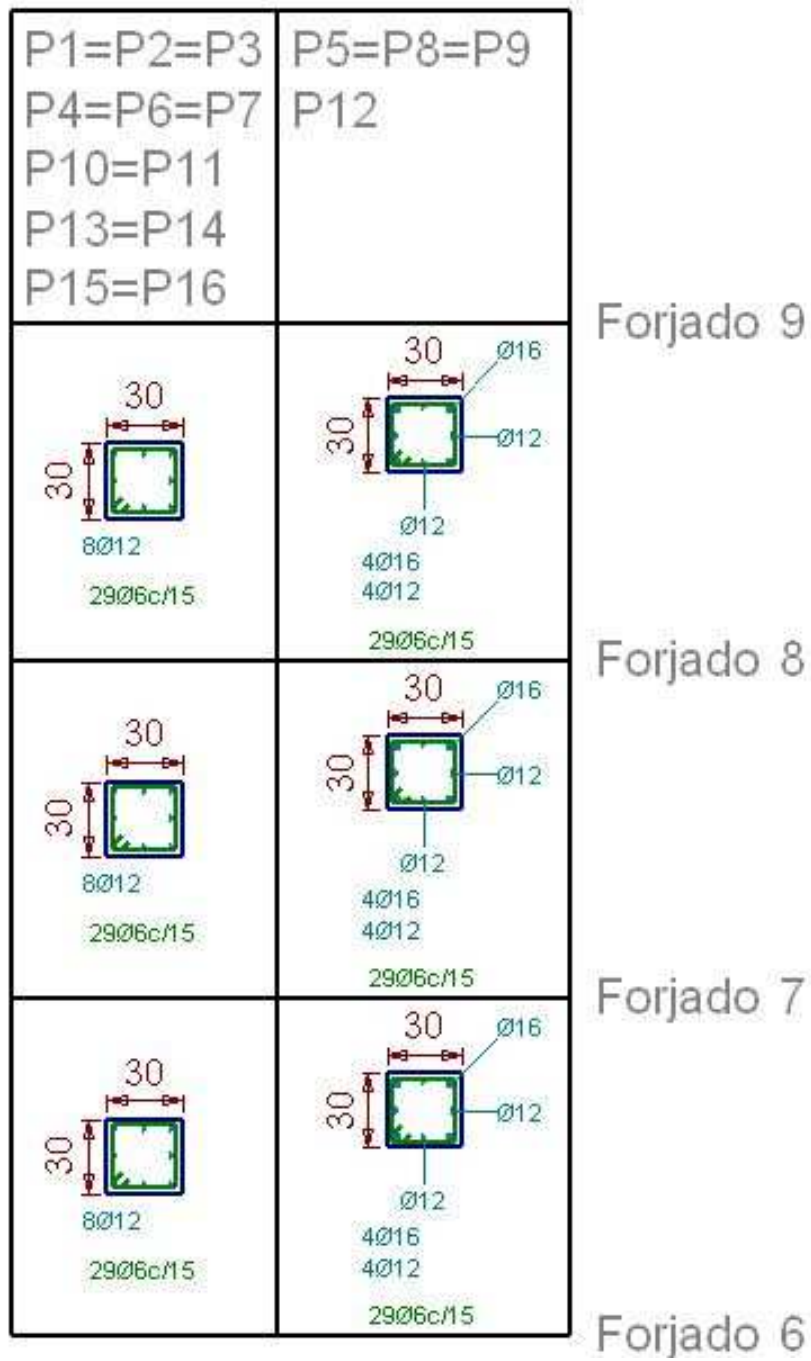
Armadura en pilares (1). Edificio de 9 plantas (G).
